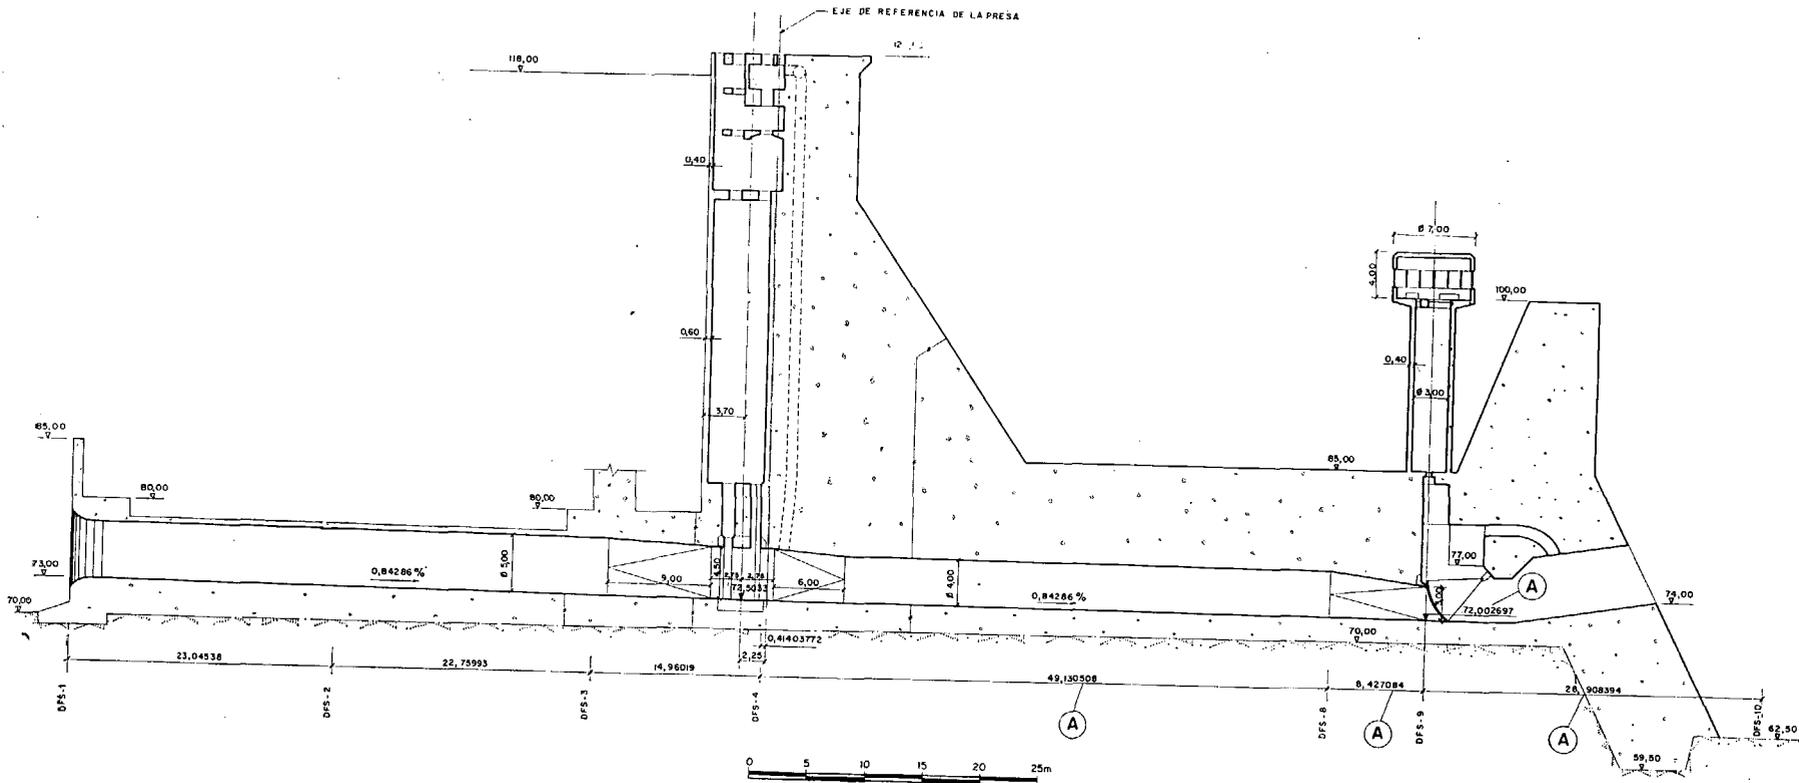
Desagüe de fondo M. I. Sever. Perfil longitudinal.
